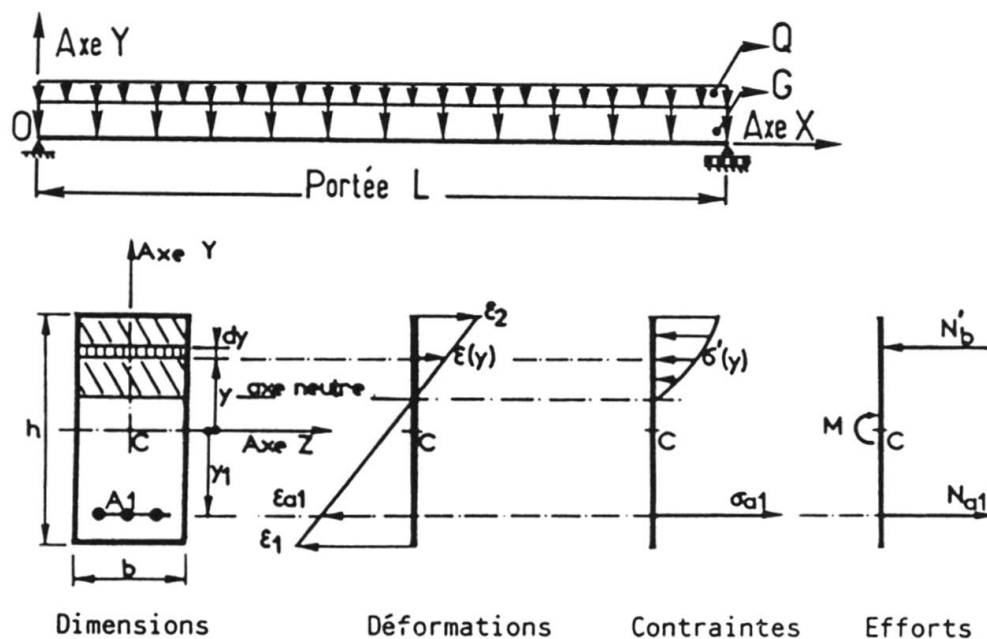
Définition de la poutre étudiée. Equilibre de la section centrale.
